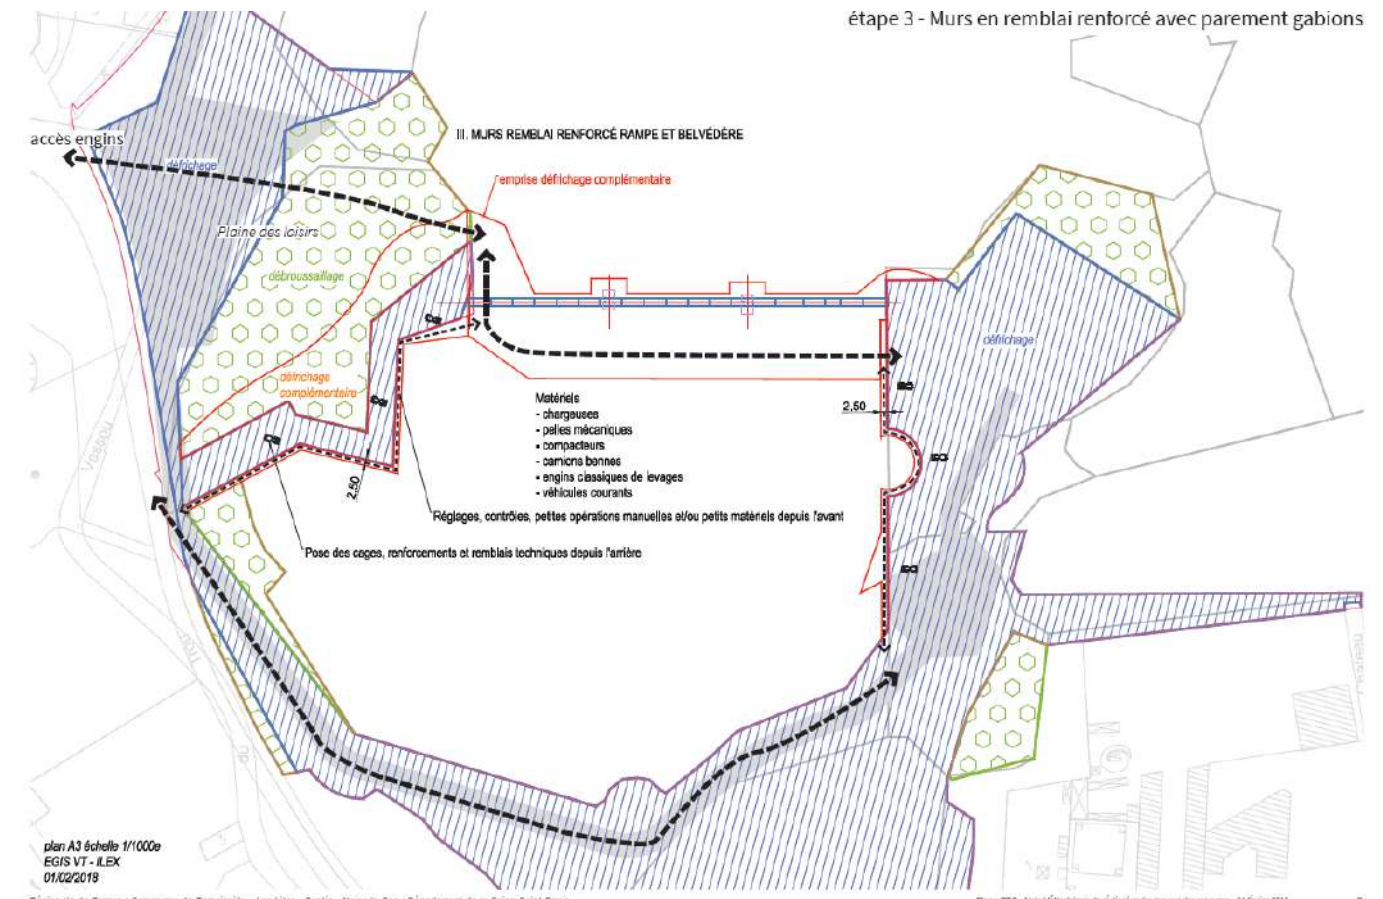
étape 3 Murs en remblai renforcé avec parement gabions – source : ILEX
